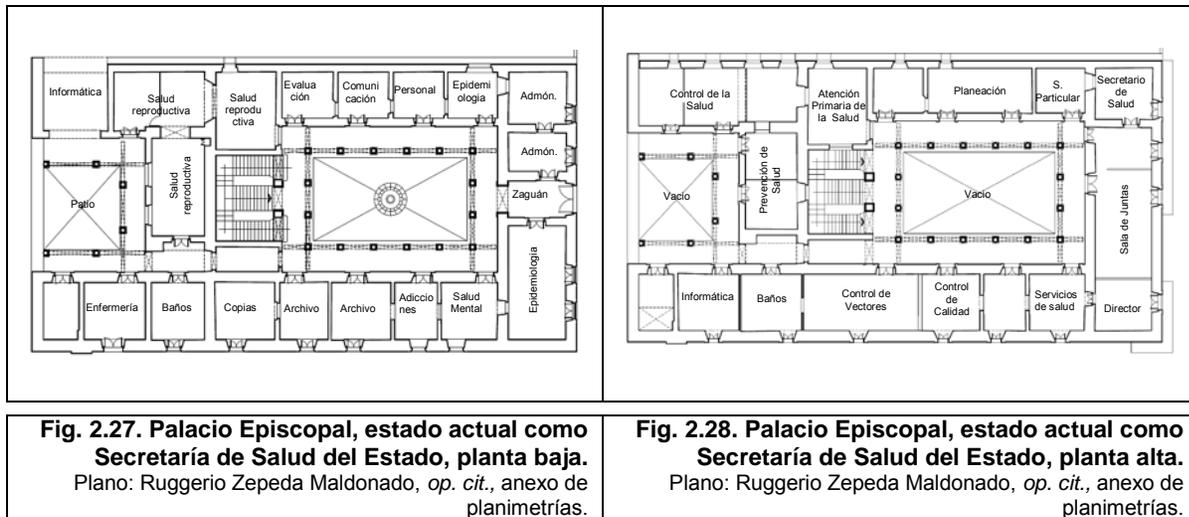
Palacio Episcopal, estado actual como Secretaría de Salud del Estado, planta baja.
